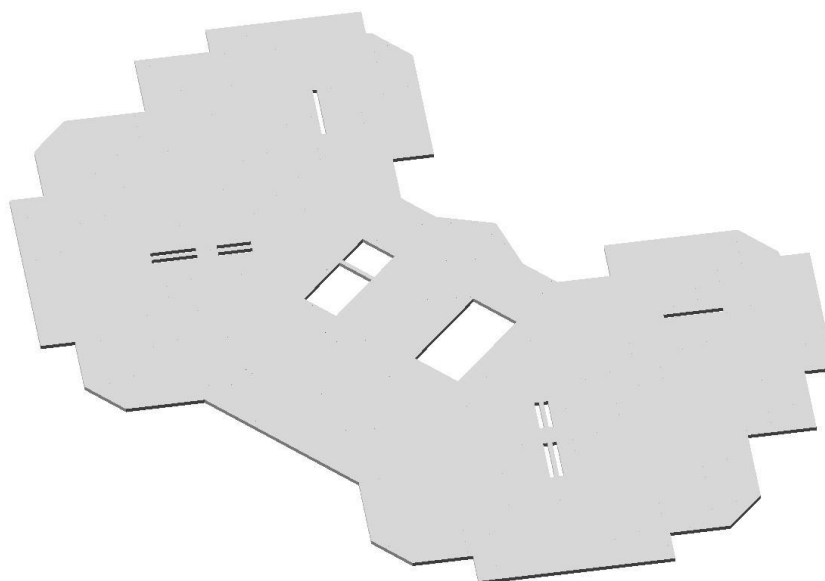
Модель плиты перекрытия типовой в 3D
